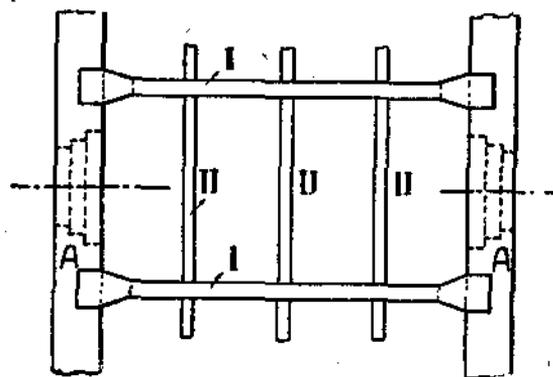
Перекрытие по металлическим балкам из досок на ребро.
